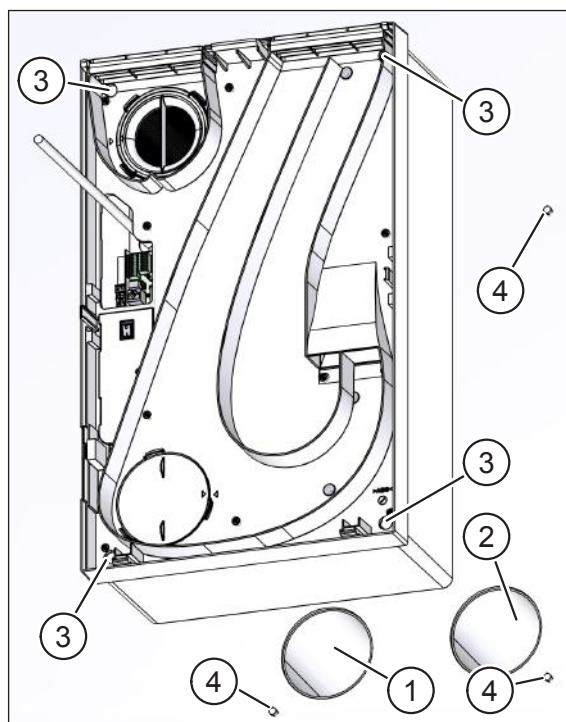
закрепить вентиляционную установку – настенный монтаж
